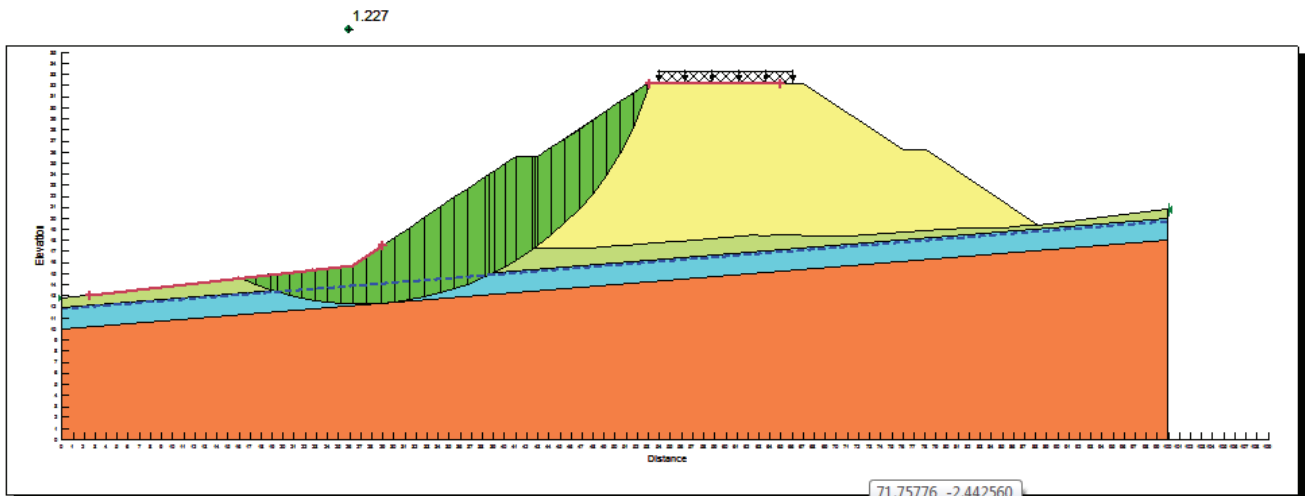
Sezione A1-34 – pk 0+480 – Analisi di stabilità in condizioni statiche
